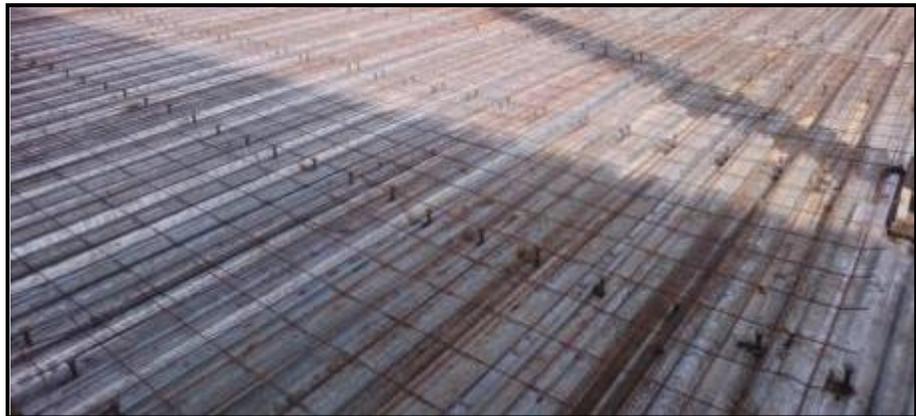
Riego de la malla electro soldada. (Fuente: Autoría Propia)
